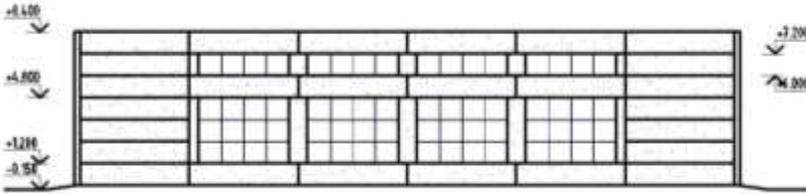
Фасад производственного здания с возможным размещением оконных проемов
